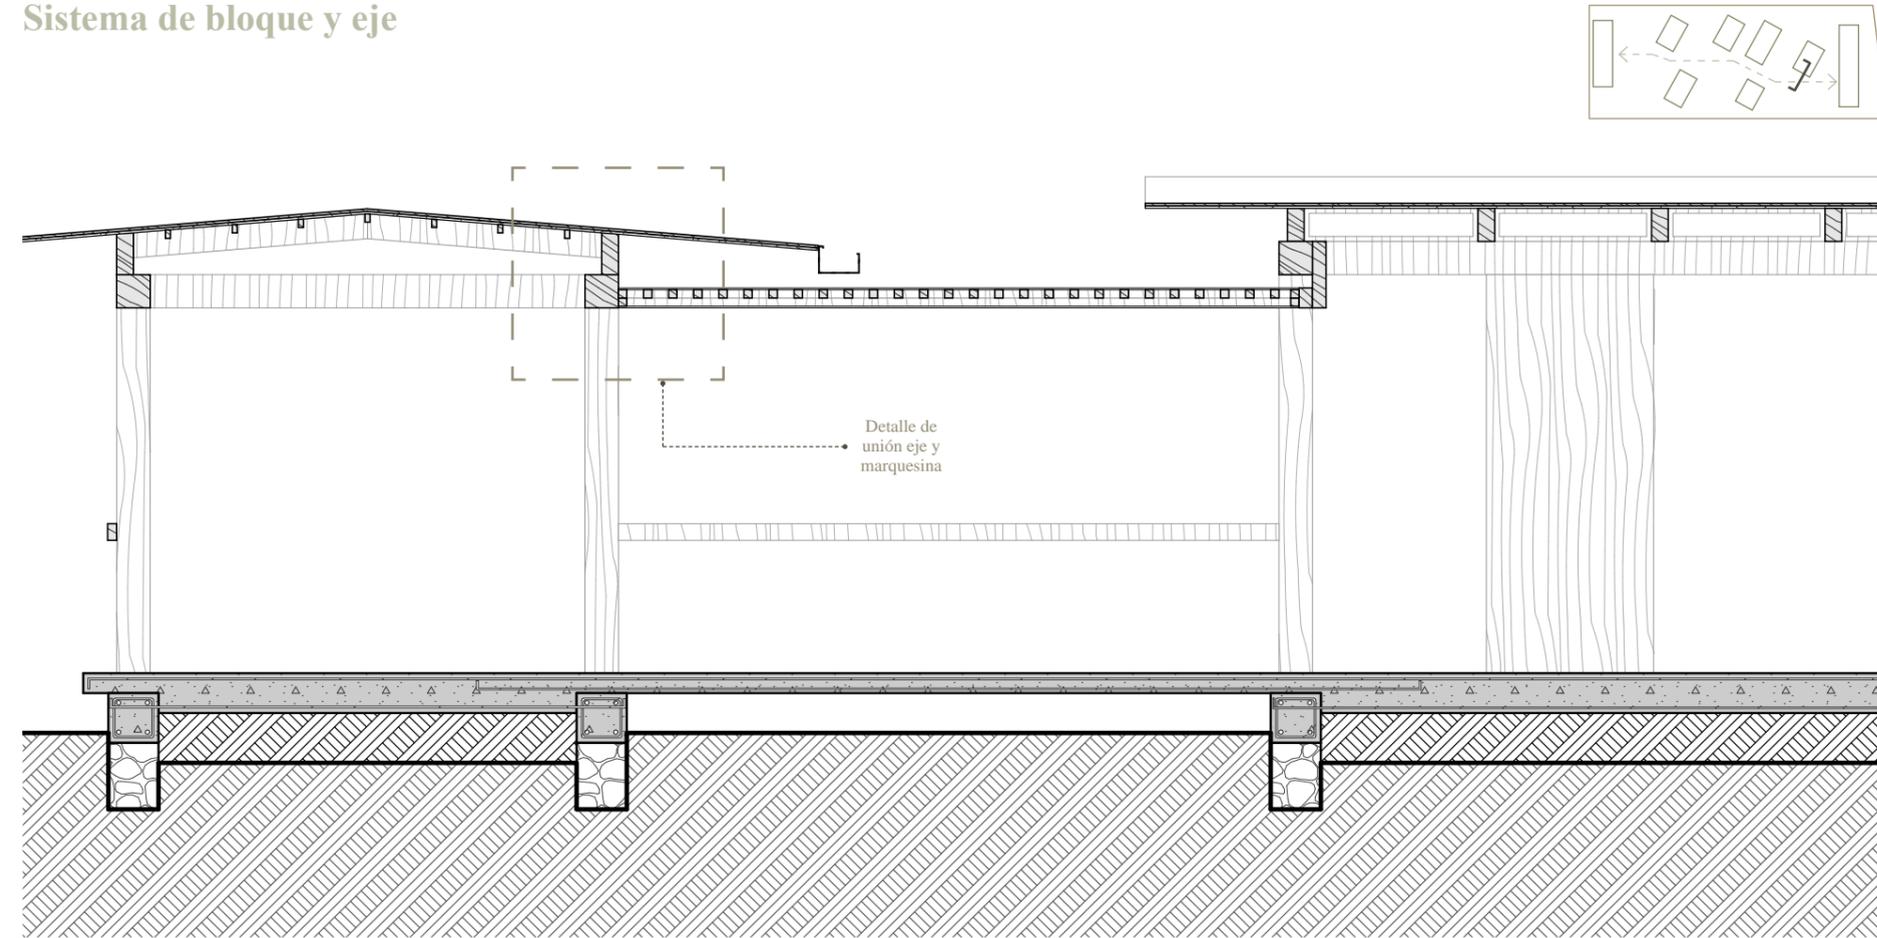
Detalle constructivo de la unión columna con losa de cimentación, Autoría propia, 2025
